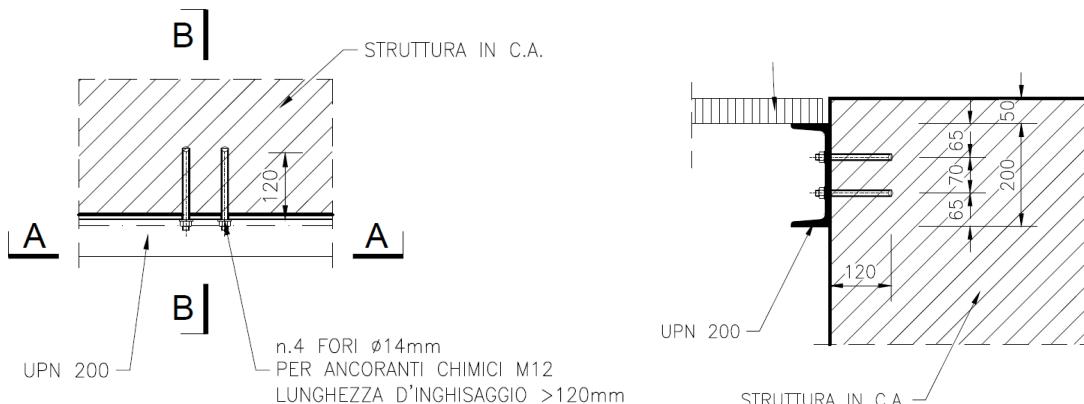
Pianta e sezione della connessione UPN200 - "Particolare 1"
